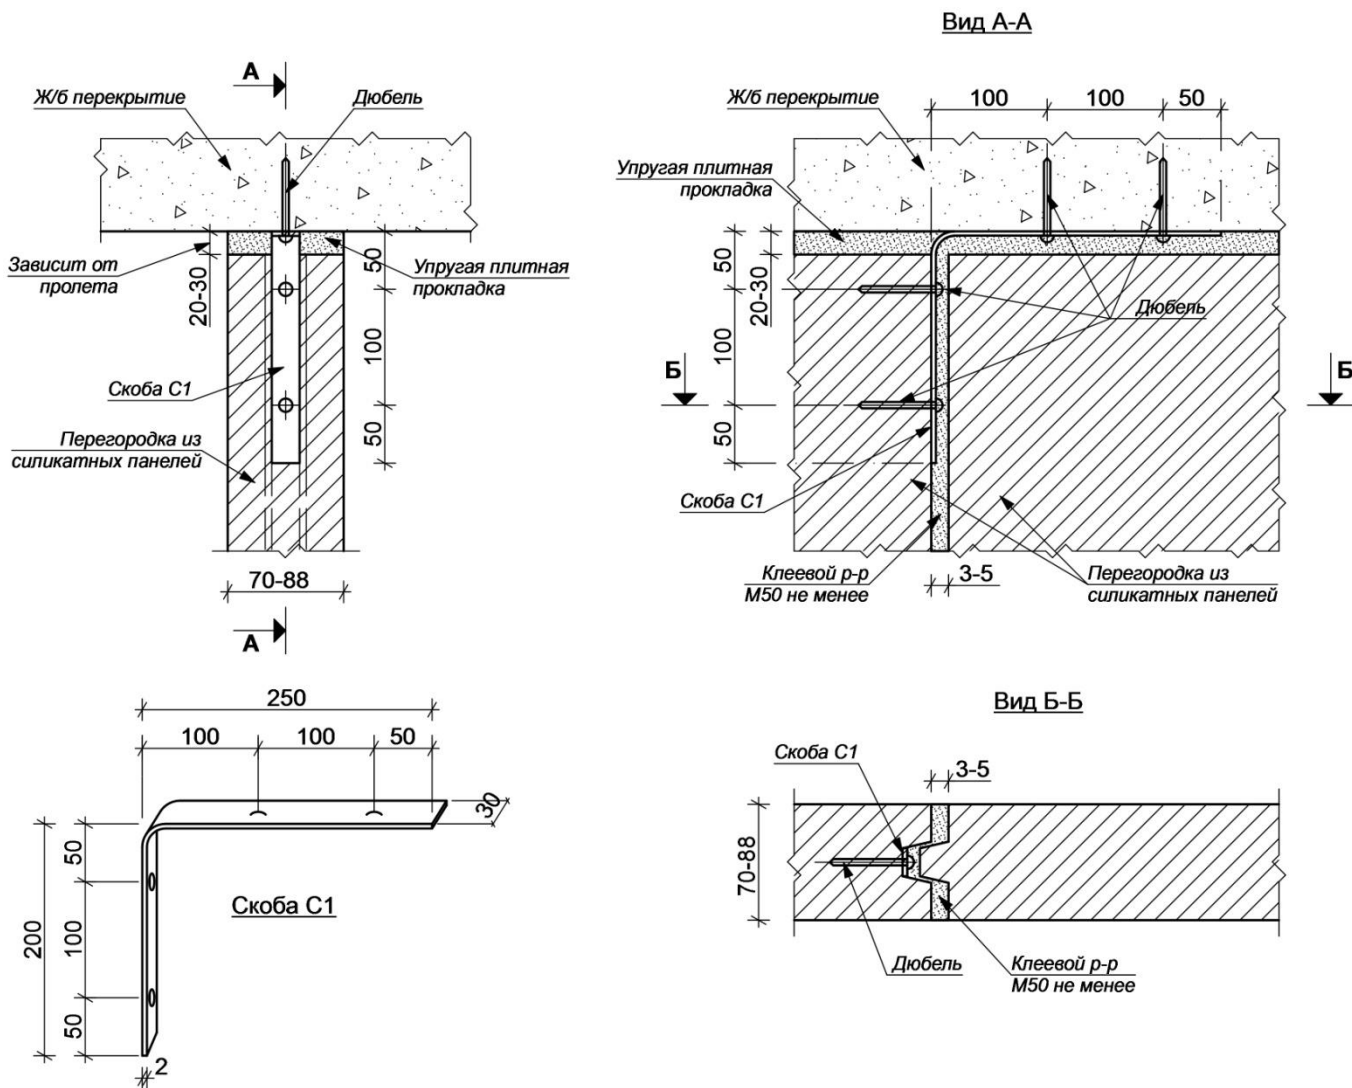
Узлы крепления перегородок к перекрытию
